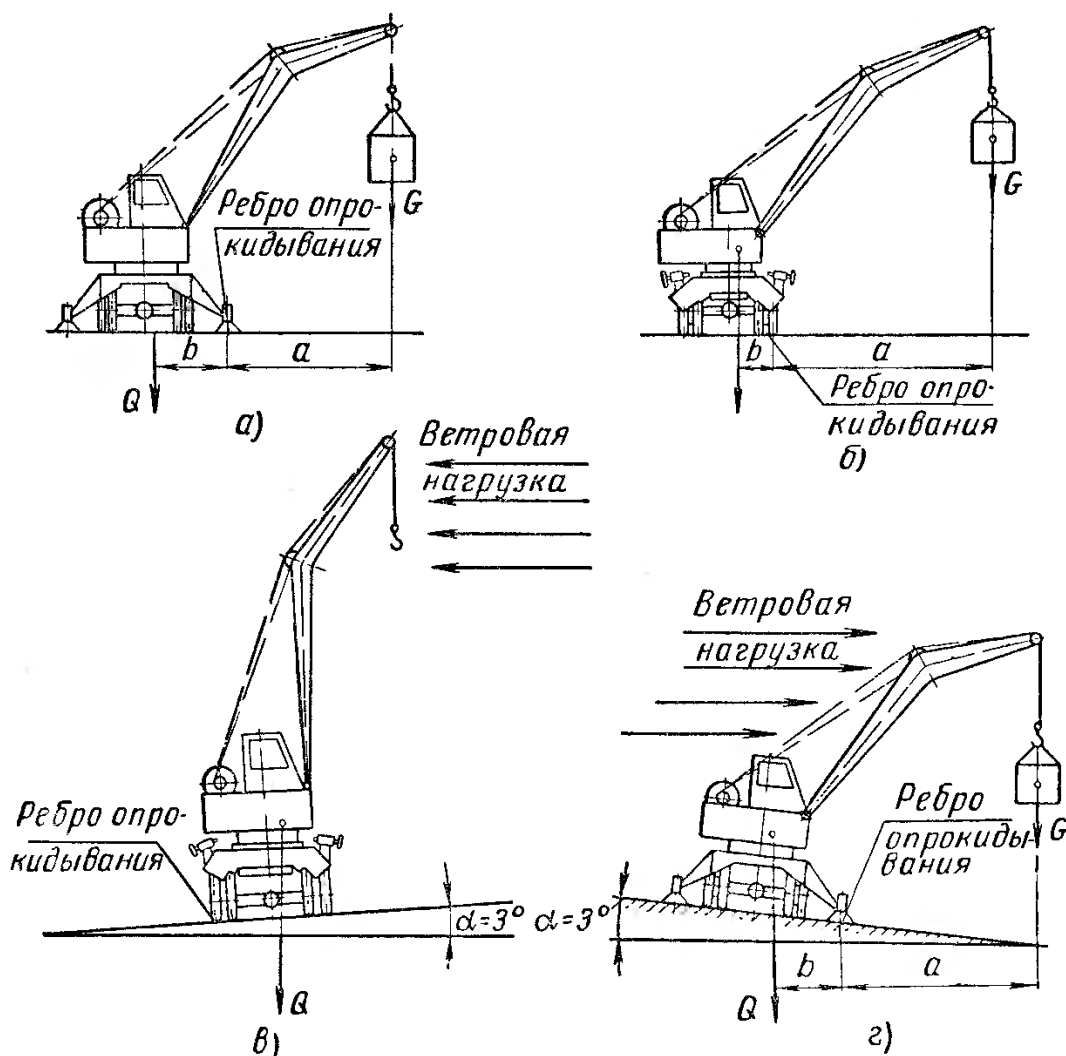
Схема к расчету устойчивости крана на выносных опорах (а и б), без них (в) и при работе на уклоне (г)
